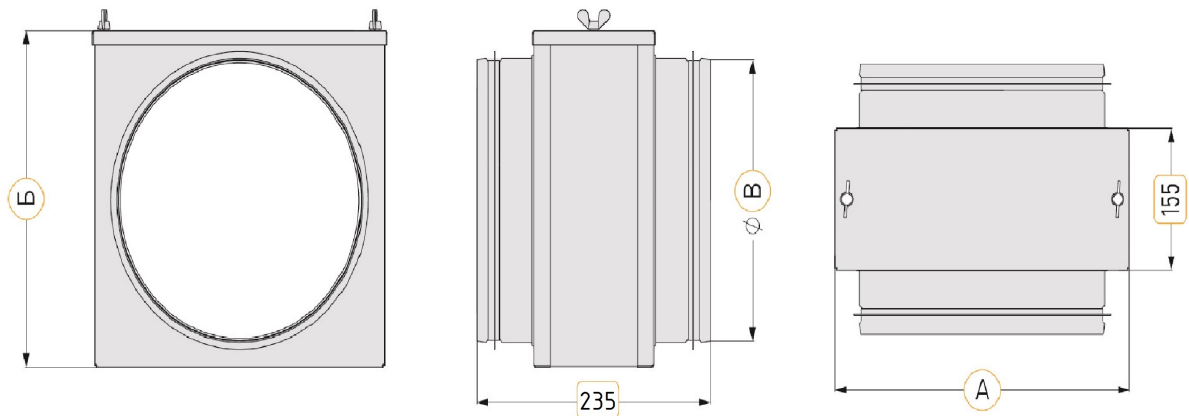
Внешний вид и основные размеры фильтров ККФ
